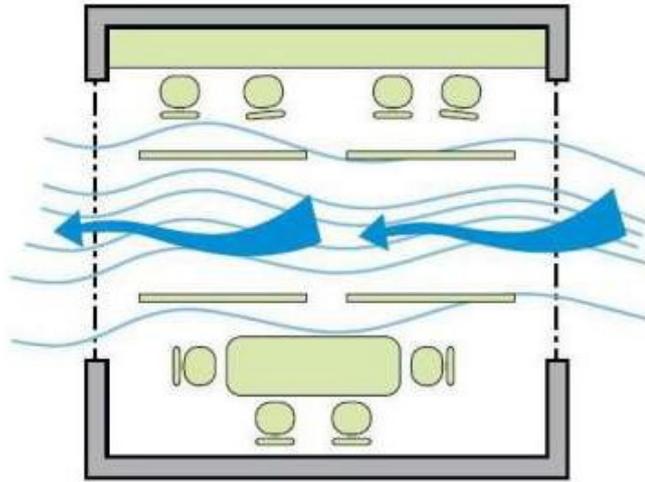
Movimiento de la ventilación cruzada en vista en planta
